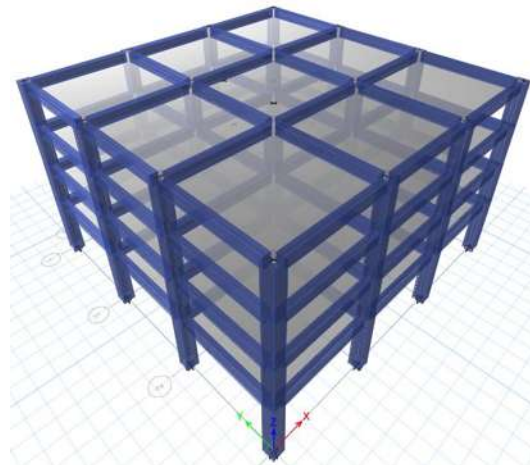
Modelos tridimensional para el edificio de 4 niveles sin muros diafragma de mampostería
